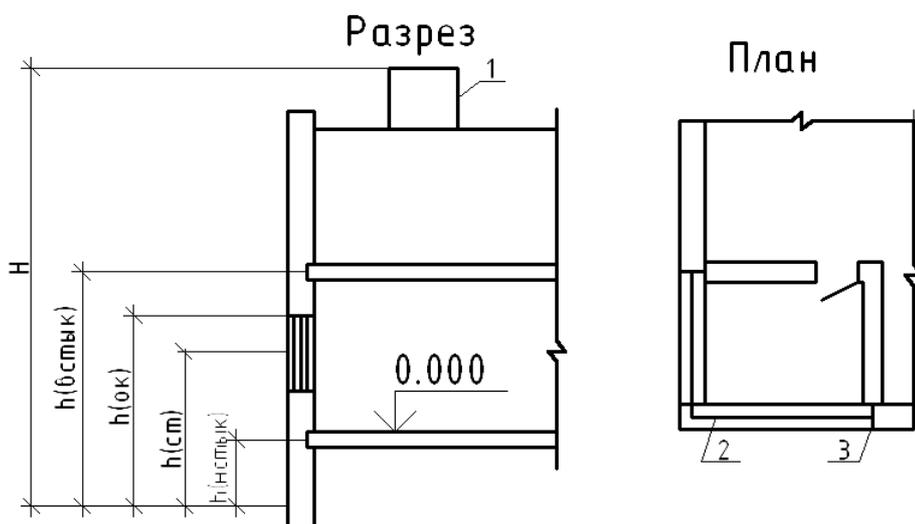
План помещения и разрез по зданию: 1- вытяжная вентиляционная шахта; 2- горизонтальный стык; 3-вертикальный стык.
